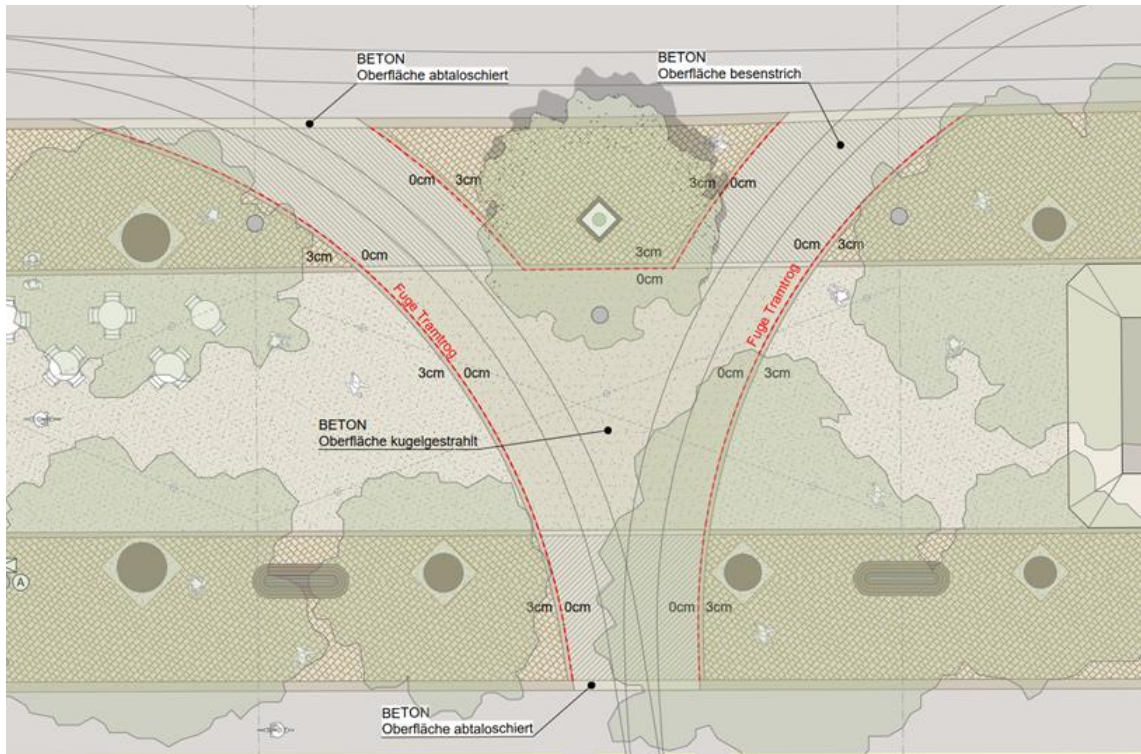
Ausgestaltung Tramwendeschleife (inkl. Oberflächenbearbeitung Beton)
